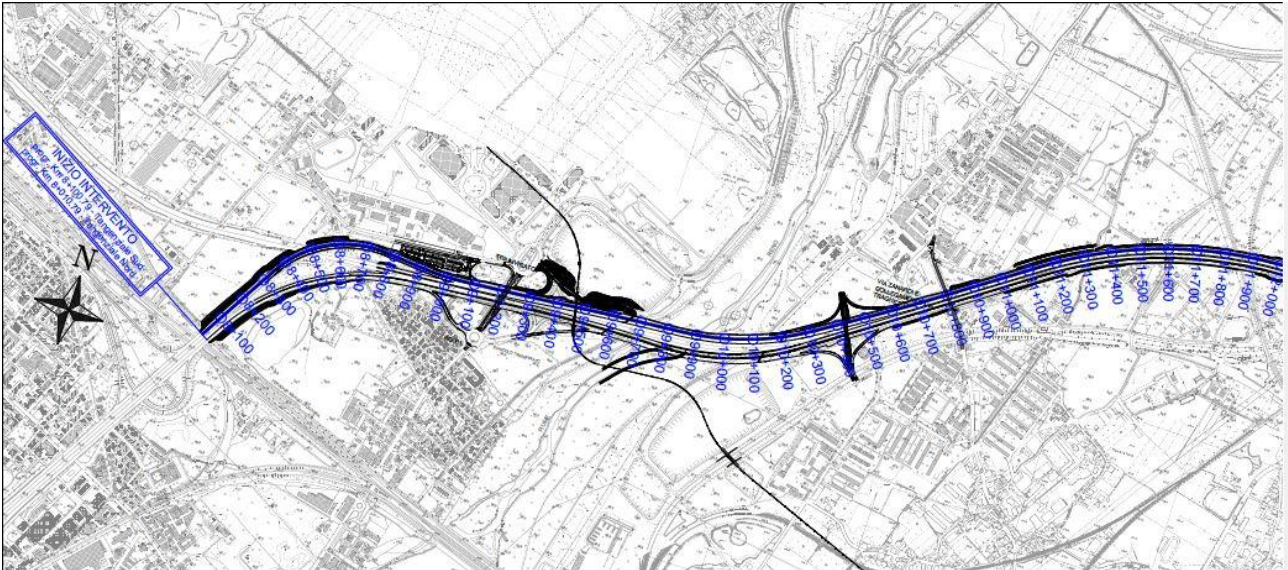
Planimetria dell'area di intervento (parte 1).
